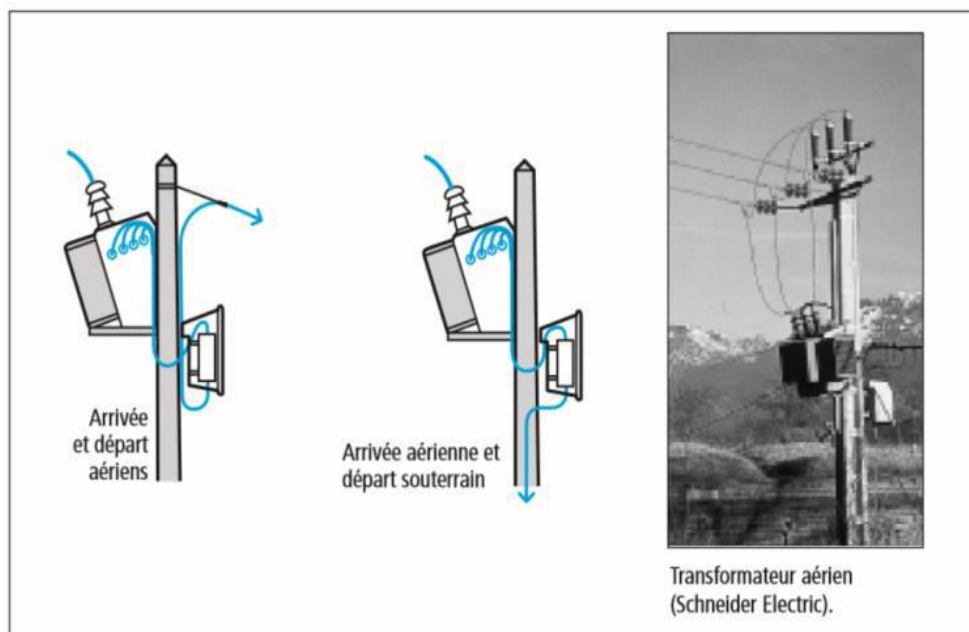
Exemple de raccordement d'un poste sur poteau.
